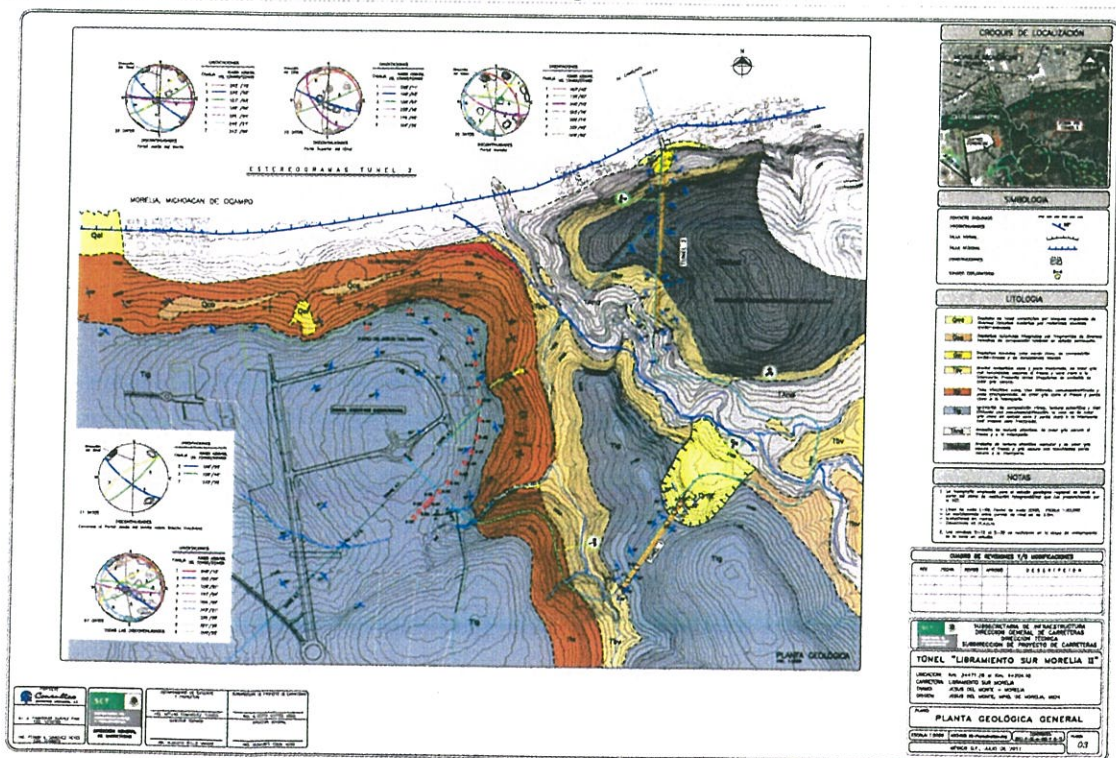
Planta y Perfil Geológico de Detalle del Túnel II.
